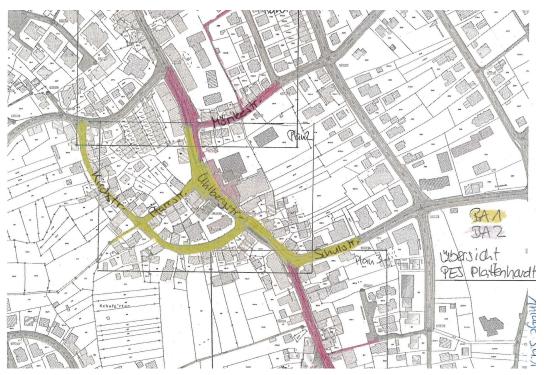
(Übersicht "PES Plattenhardt", Darstellung Stadt Filderstadt)
